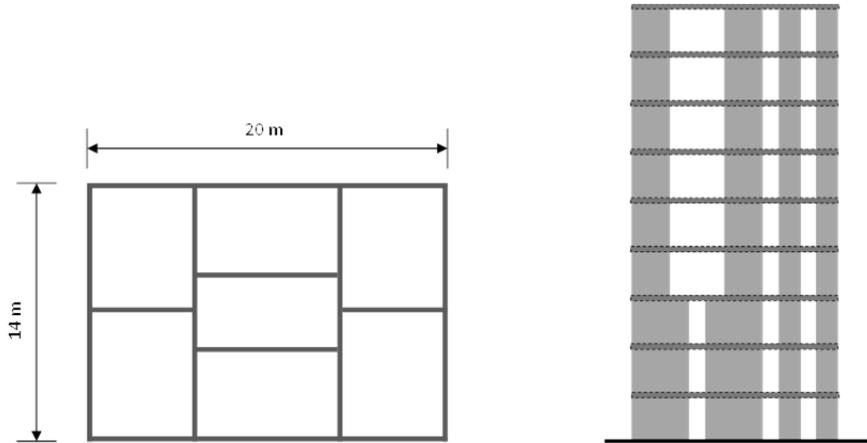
Grundriss und Ansicht einer Fassade
